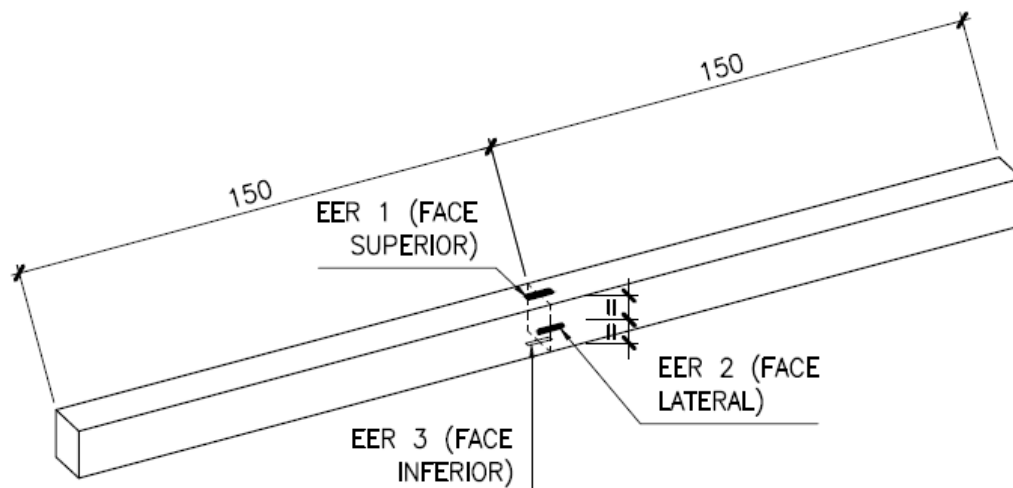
Posicionamento dos EER nas vigas de madeira – tipo 1 (dimensões em cm).
